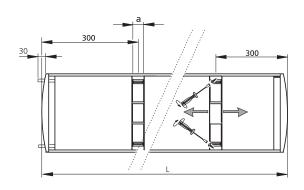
Horizontaler Anschluss im Endstück -H, Draufsicht. a = Justiermaß für Aufhängungsteil ist 43 mm.
